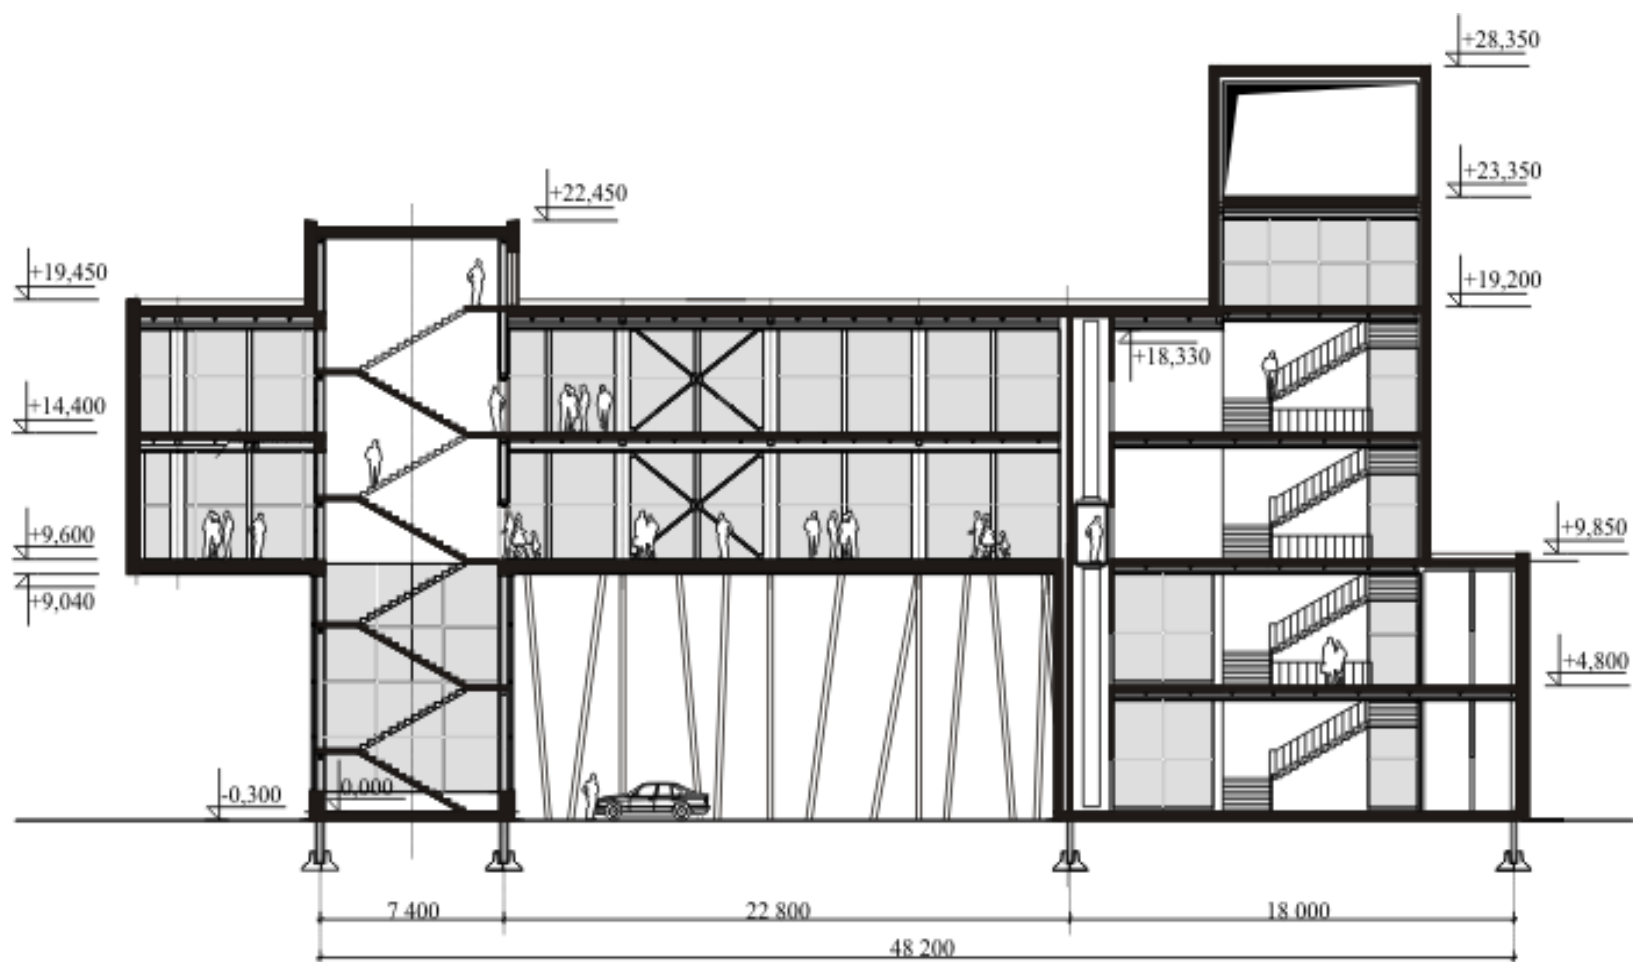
Продольный разрез нового корпуса научной библиотеки университета
